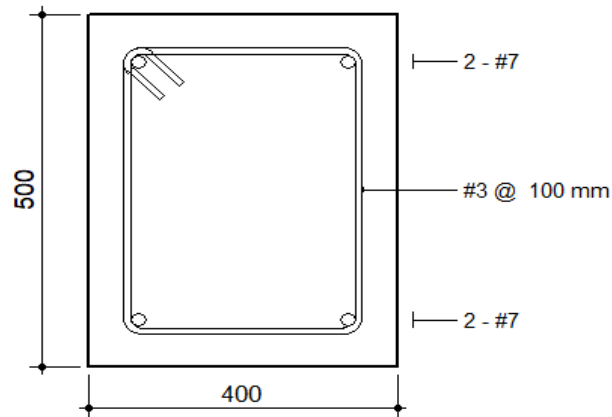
Sección de viga perimetral plantas 5 y 6. Fuente: Propia.
